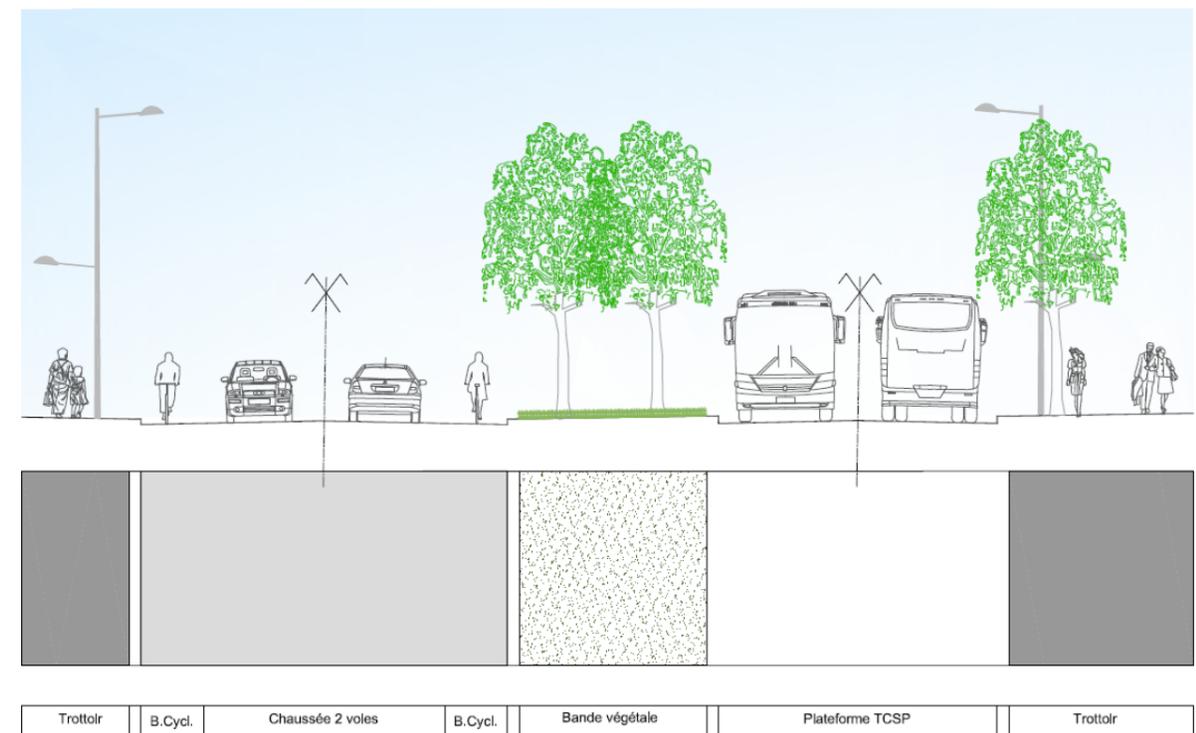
Coupe de principe sur le Boulevard Nord Section 2
